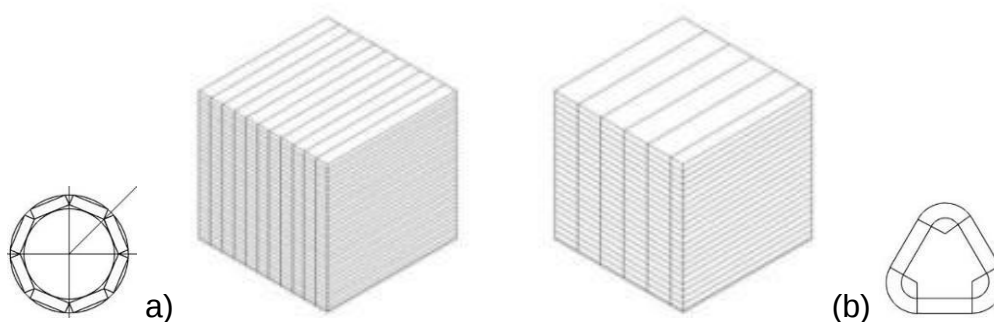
Líneas de pega en 1m³ de viga laminada (a escala)
